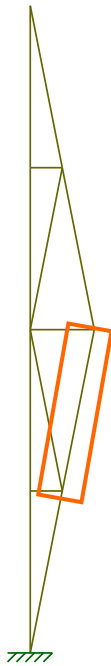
Sollecitazioni pilastro reticolare di bordo
